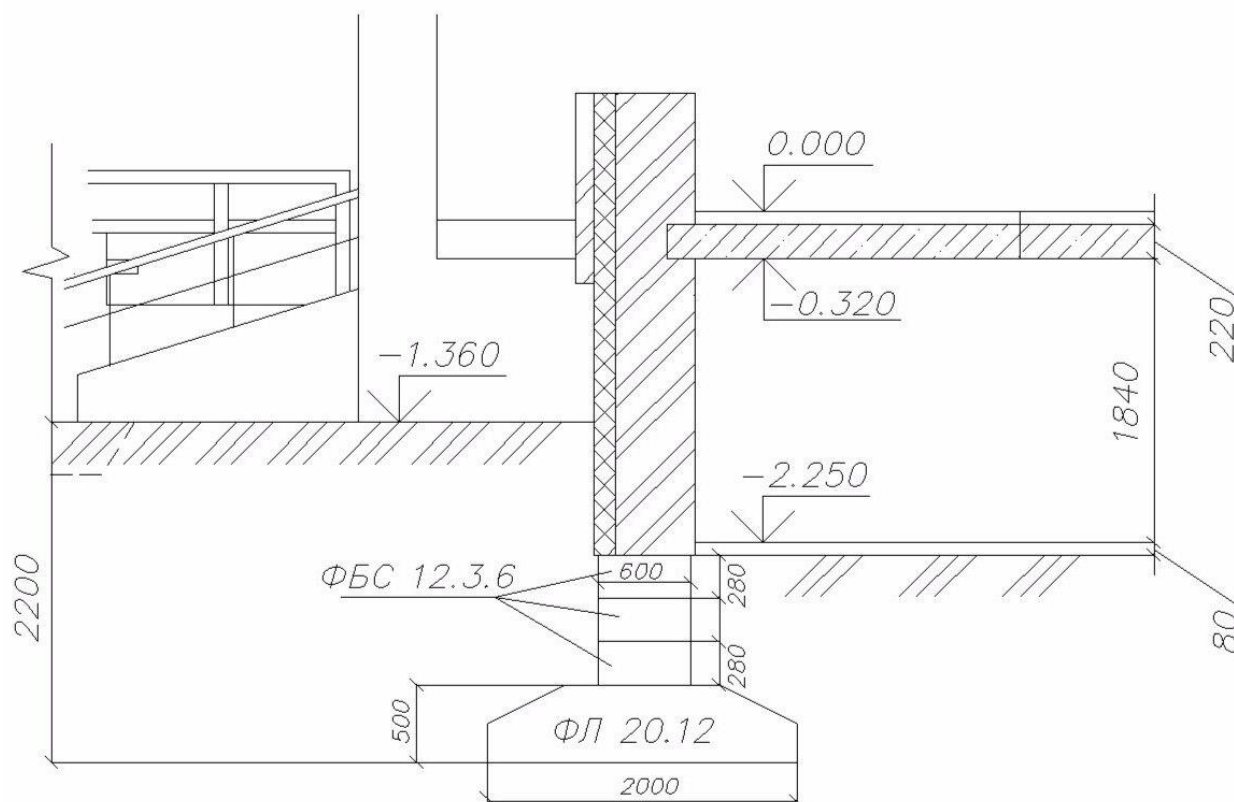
Схема к определению подошвы ленточного фундамента
